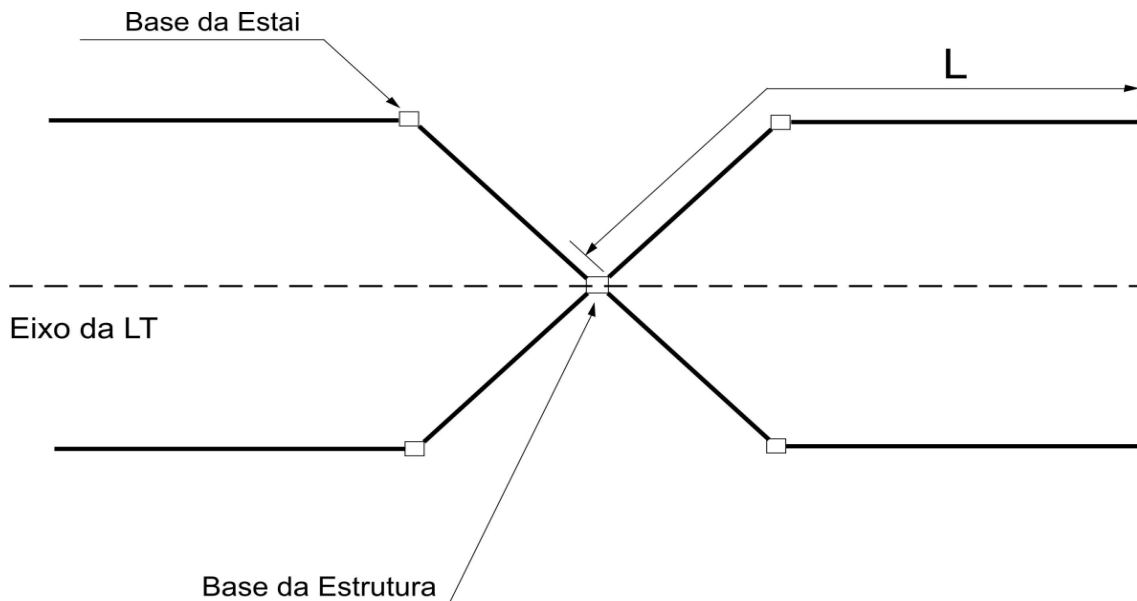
Aterramento de Estruturas Estaiadas
